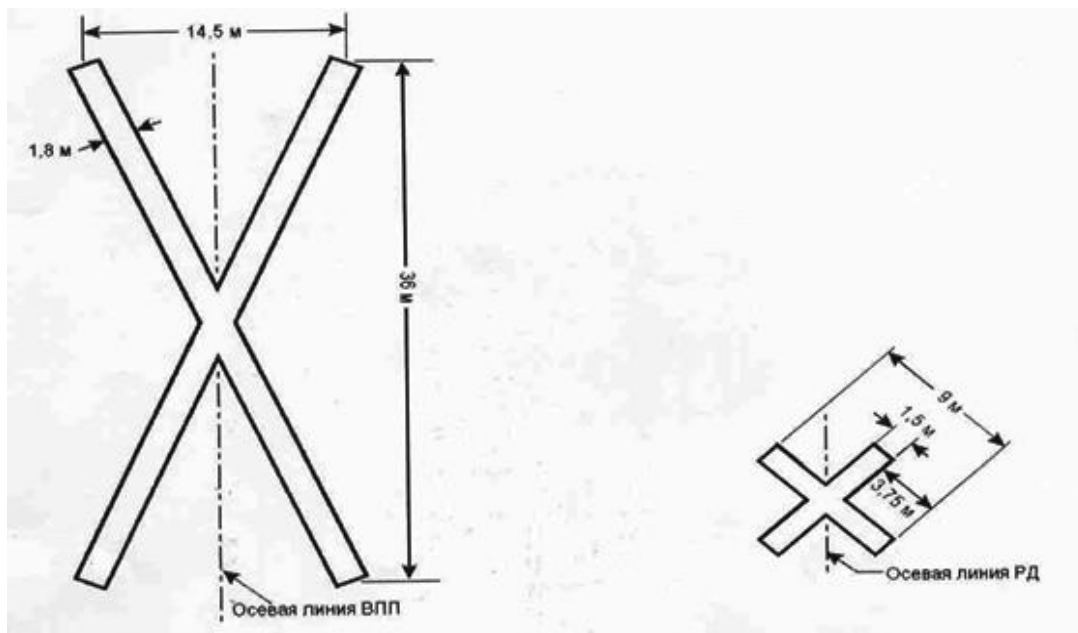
Маркировка закрытых для движения ВПП и РД
